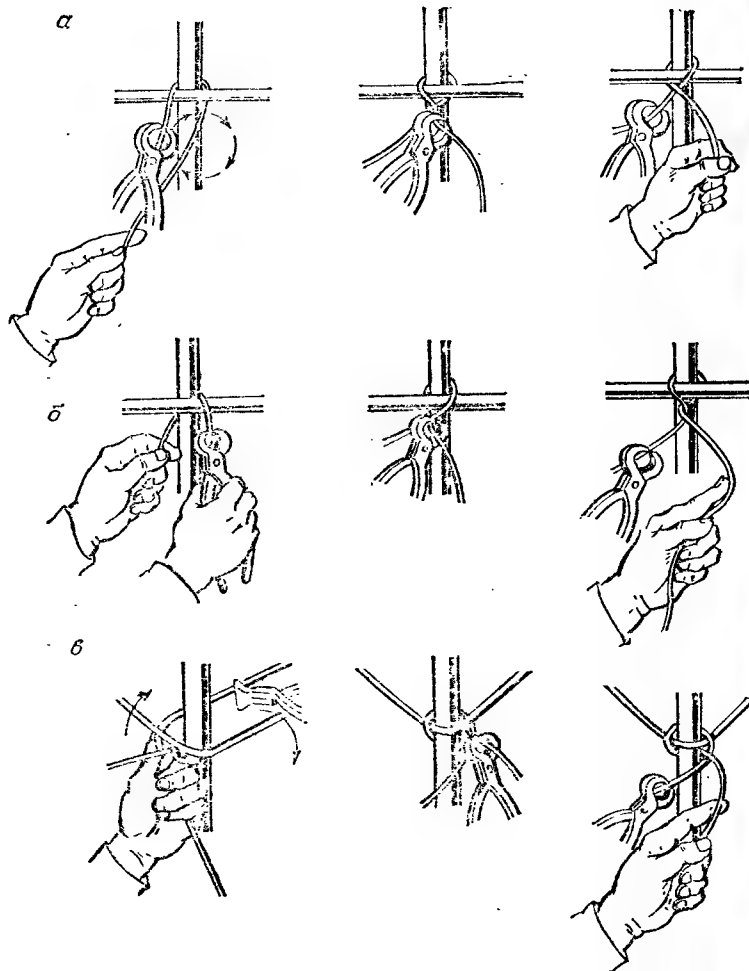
Приемы вязки проволокой пересечений арматурных стержней
